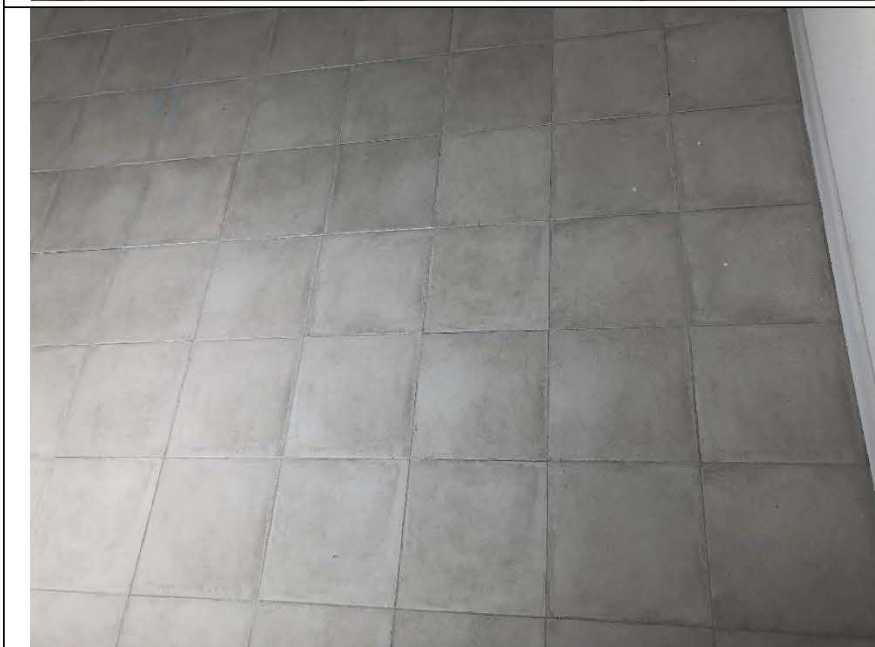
Общий вид напольного покрытия на кухне в квартире.
